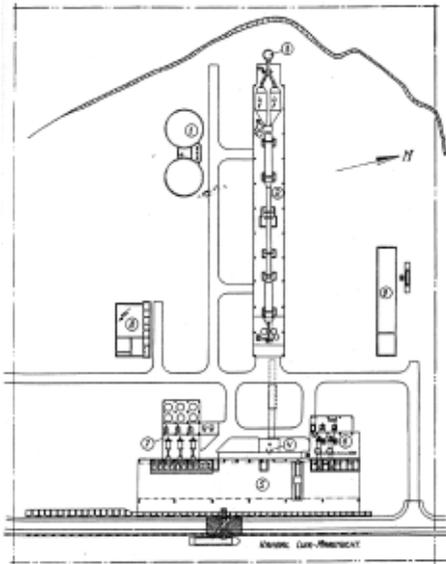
Planta primera ampliación. Con la numeración correspondiente al texto
